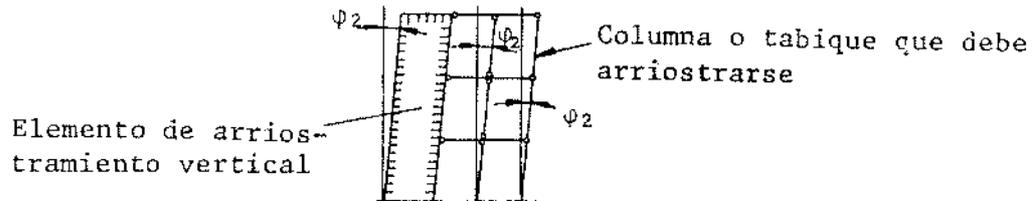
Inclinación ϕ_2 de todos los componentes verticales de arriostramiento y a ser arriostradas
